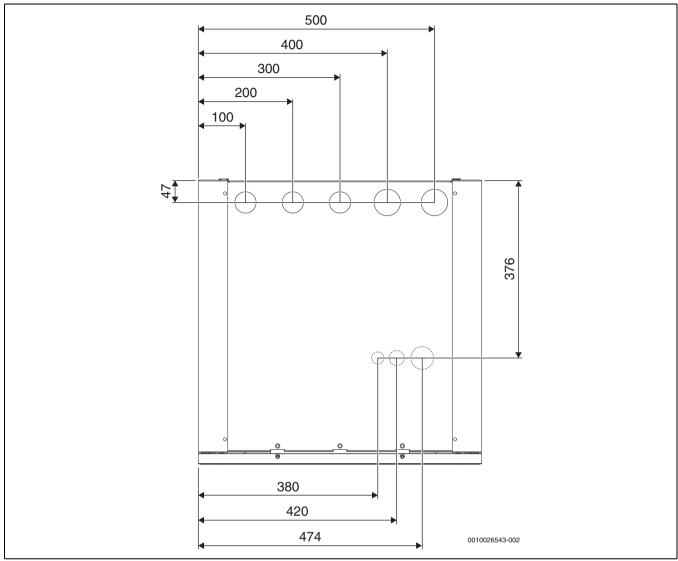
Dimensioni del collegamento, veduta dall'alto
